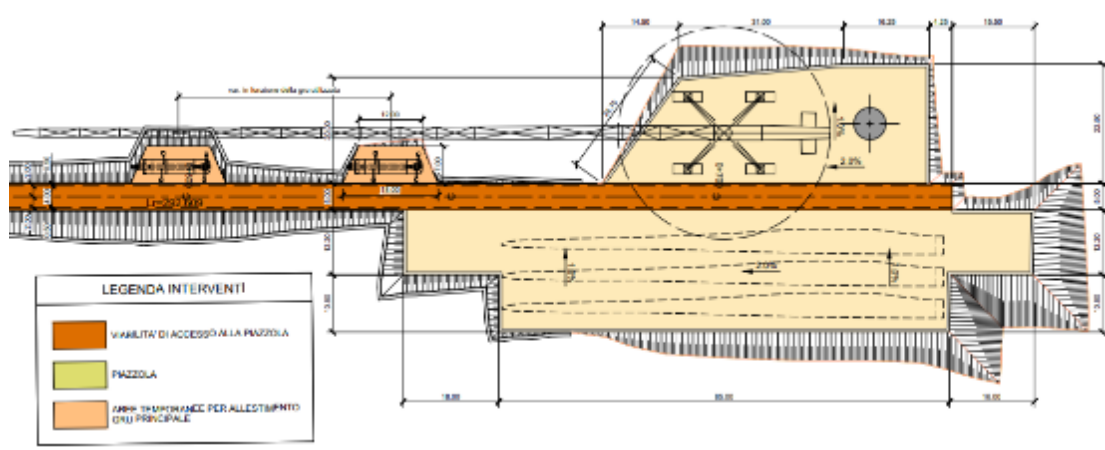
Planimetria in fase costruttiva: sistema di montaggio “Just in time”.
